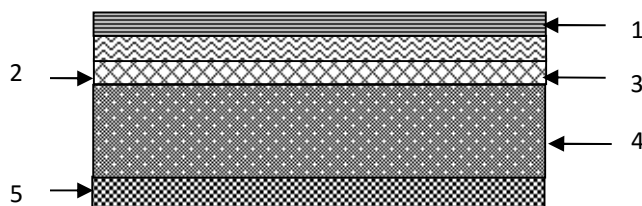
Coupe transversale dans le plancher à dalle pleine.
